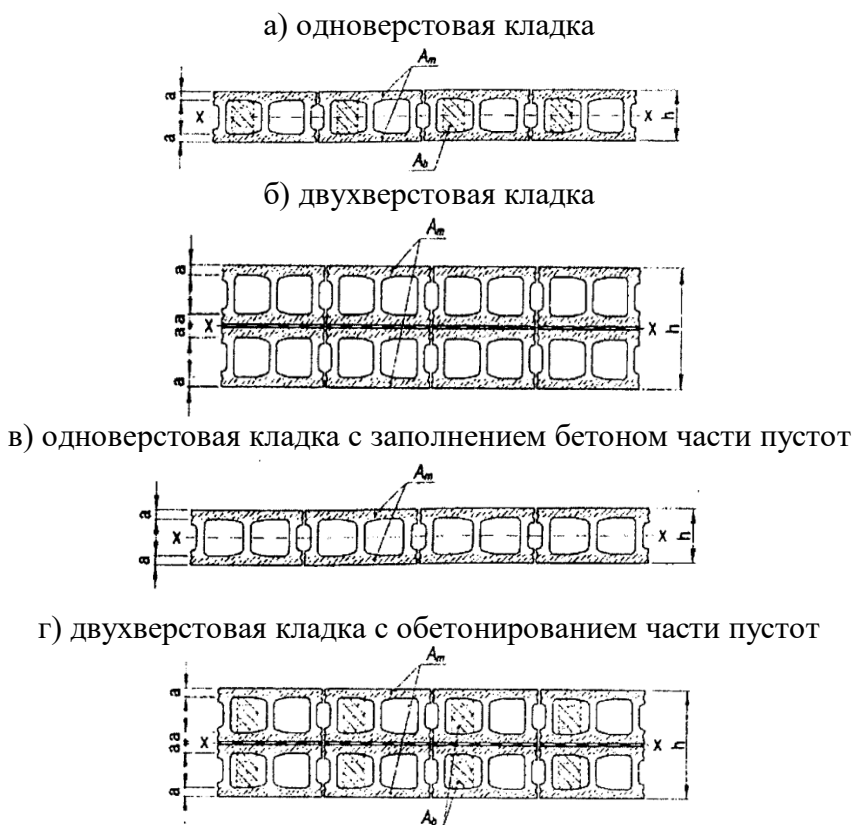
Варианты компоновки стен из высокопустотных бетонных блоков
